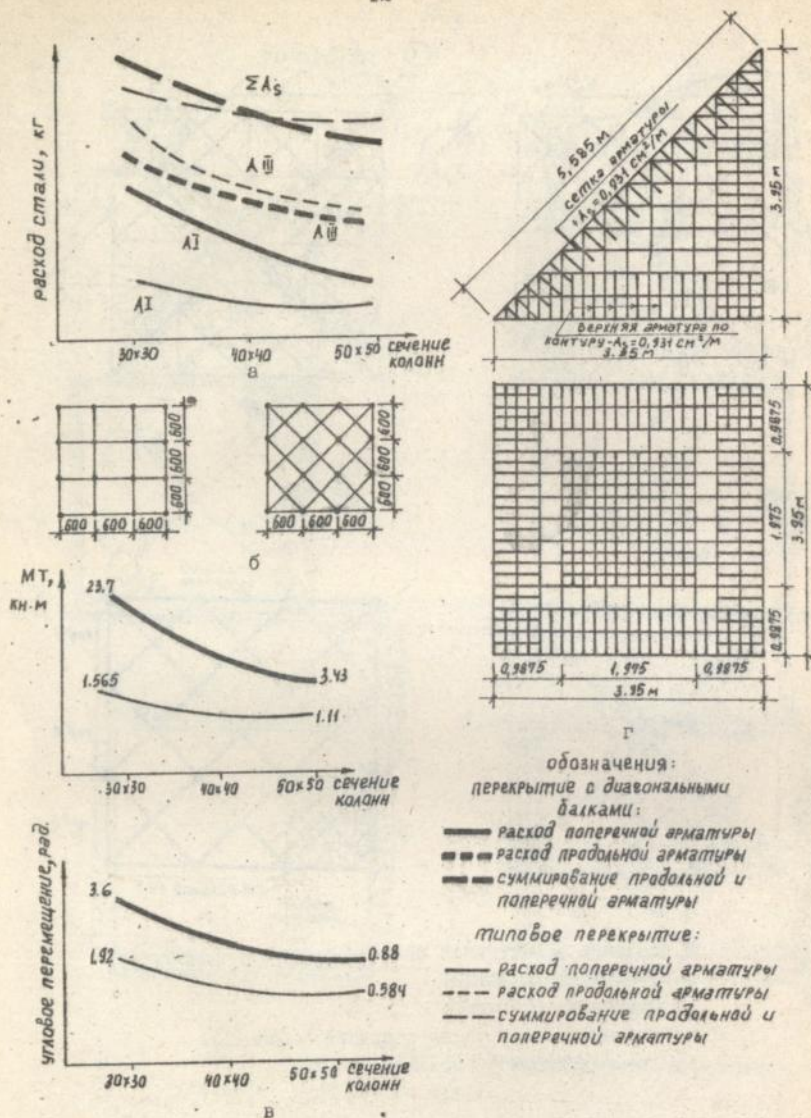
Расход арматуры (а), схемы типового и исследуемого перекрытий (б), соотношения моментов и угловых перемещений (в), армирование плит (г).
